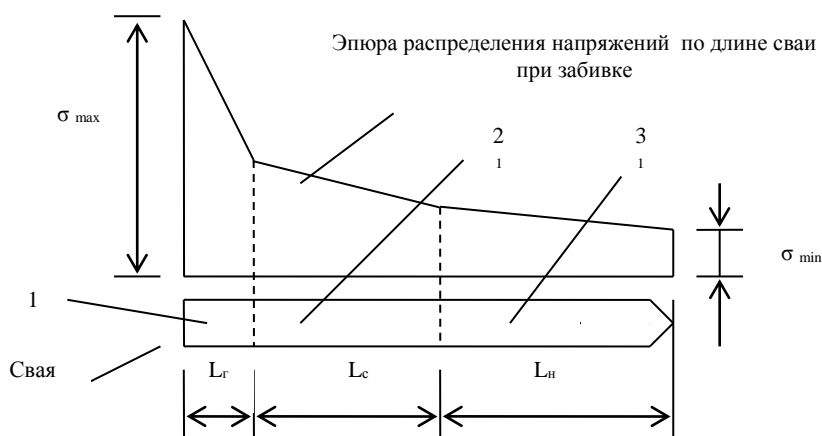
Схема сборной, железобетонной сваи с разнопрочными участками ствола
